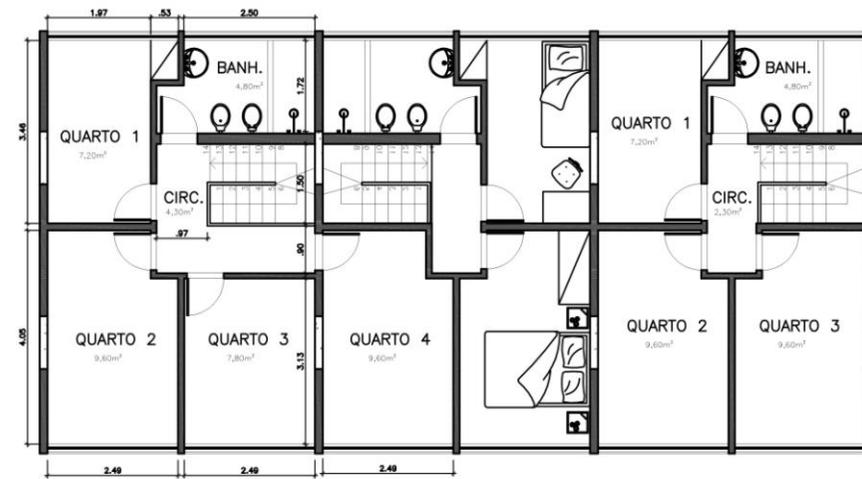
Bloco A, planta do apartamento duplex. Desenho da autora.
